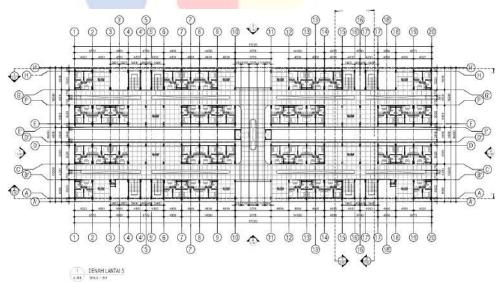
Denah Lantai 3 Rusunawa Cipinang Muara
